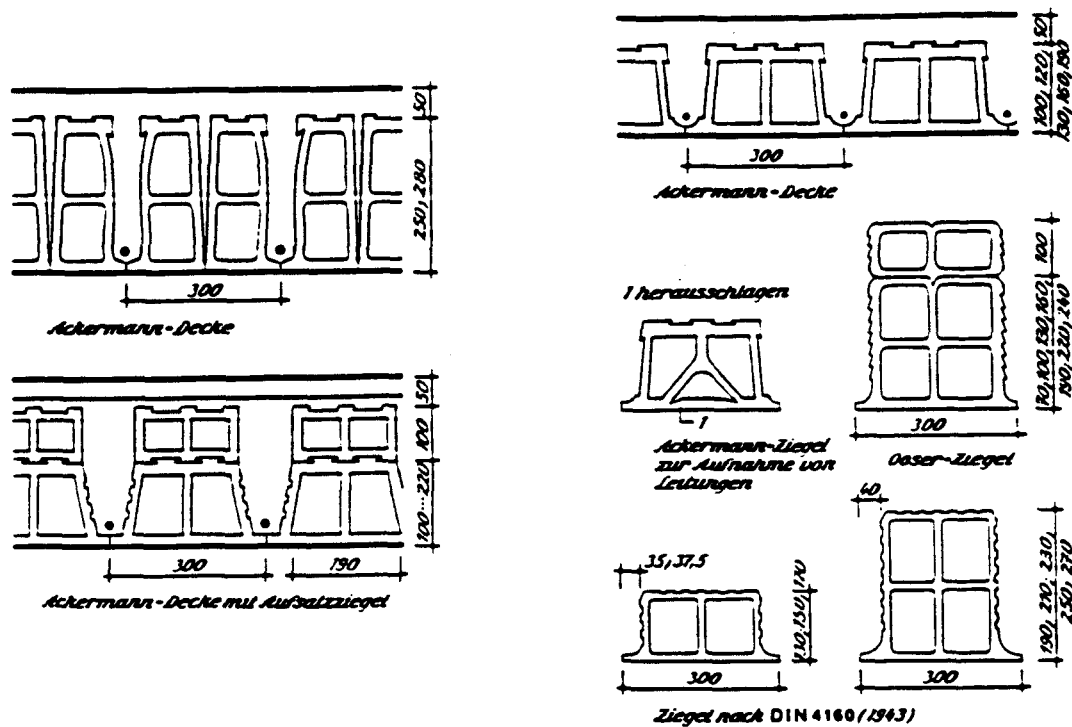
Querschnitt von Stahlbetonrippendecke mit Deckenziegeln /1/
